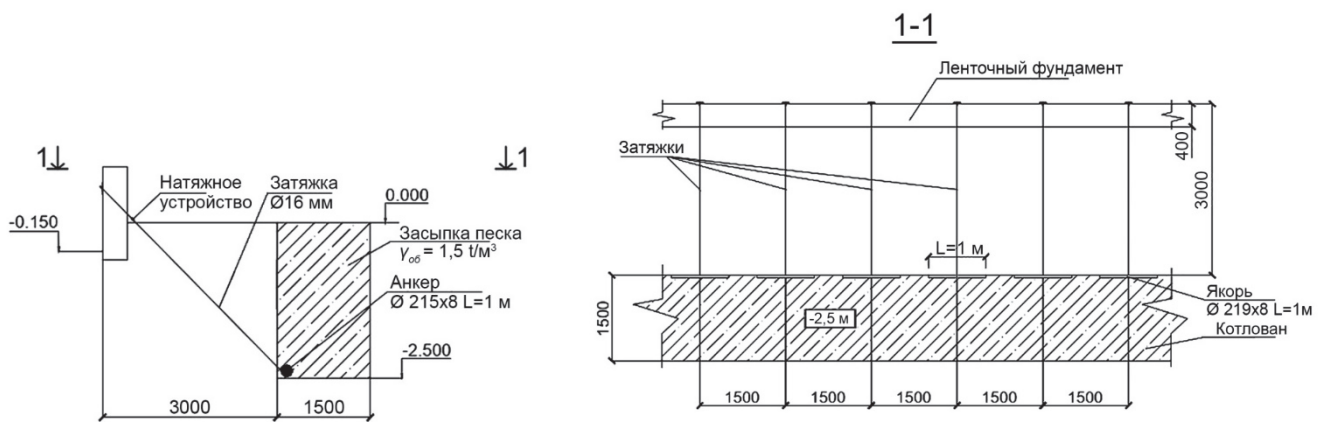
Вариант 2. Установка затяжек в ленточном фундаменте арочного здания с заглубленными стальными анкерами
